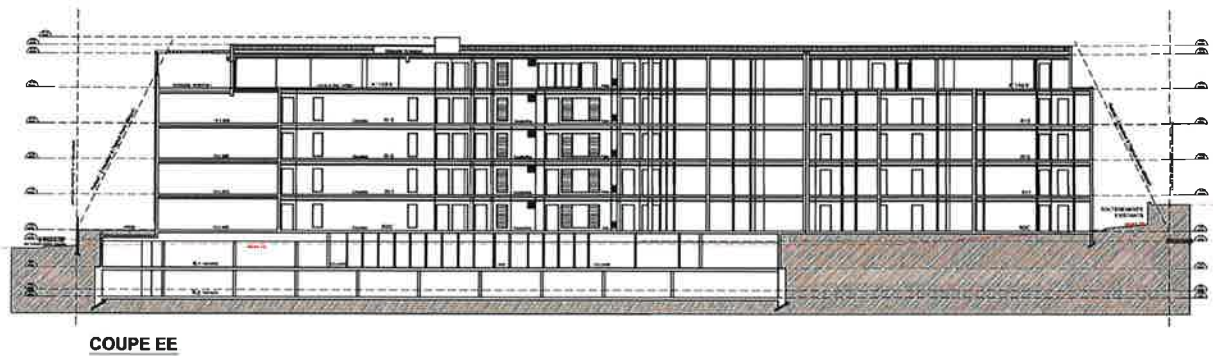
Coupe EE Nord-Sud projet (Plan reçu le 01/12/2020)
